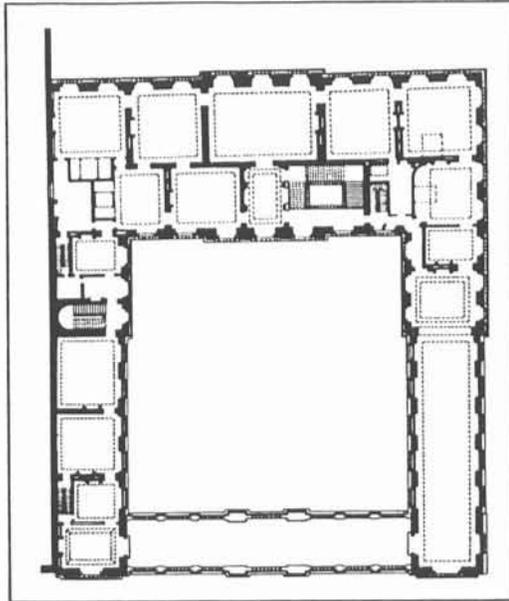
Hôtel particulier, 1691. Planta baixa.
